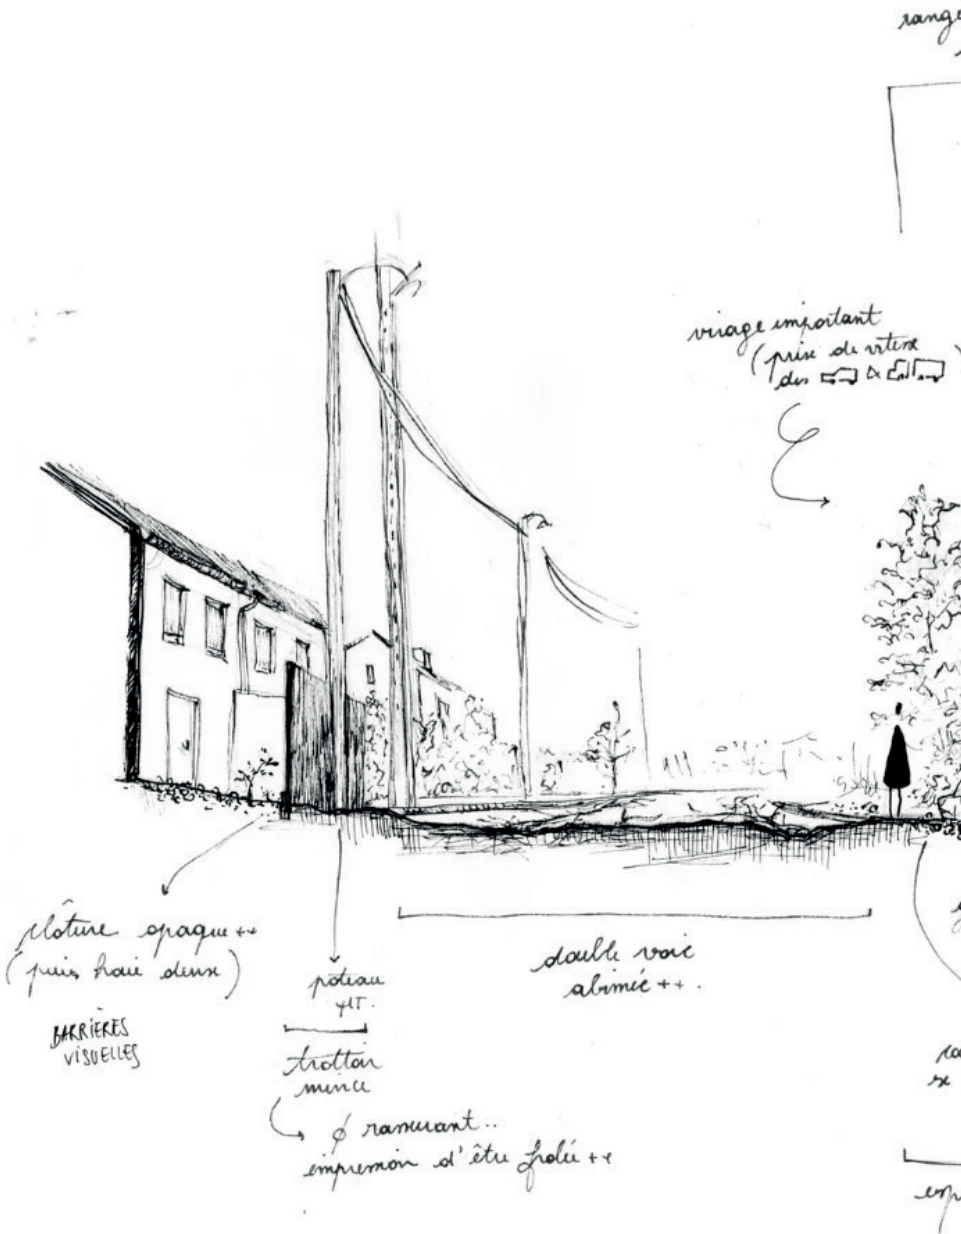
Coupe sensible montrant la place du piéton restreinte sur un trottoir
